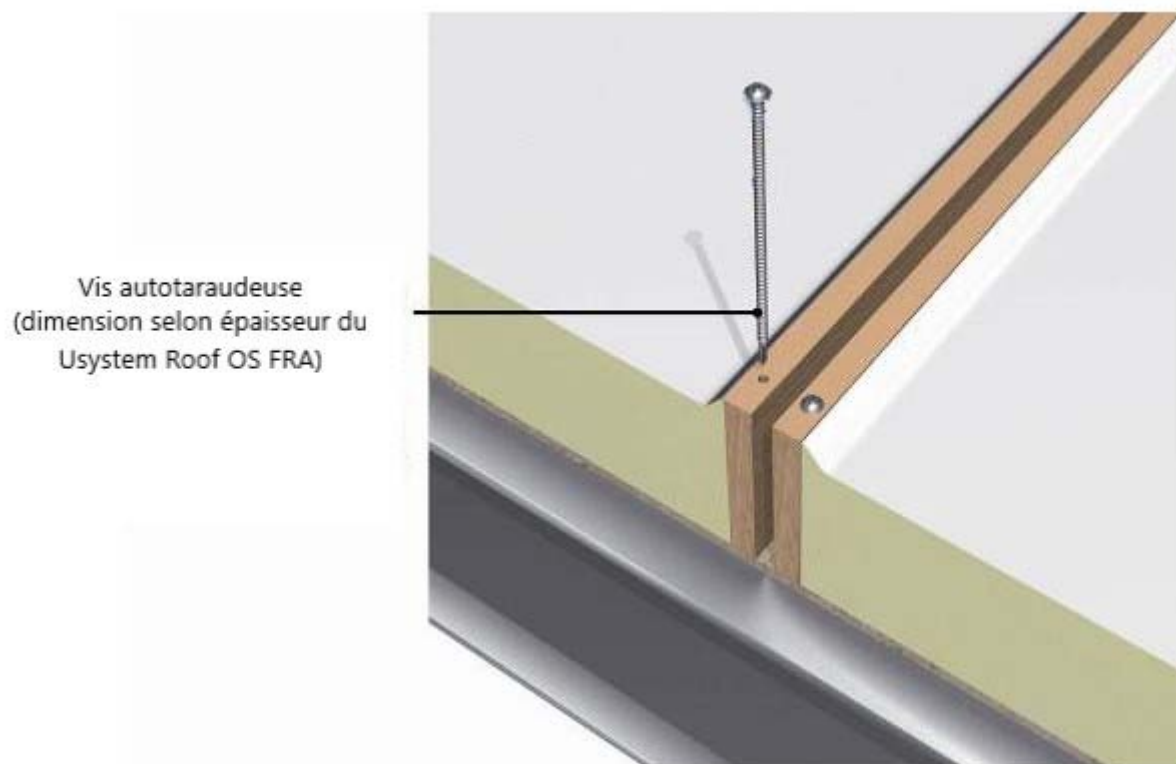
Fixation sur panne métallique Ussystem Roof OS FRA
